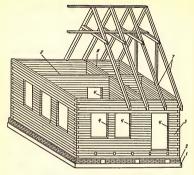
Конструкция брусчатых стен и стропил дома: 1 — фундамент; 2 — цоколь; 3 и 5 — наружная и внутренняя стены; 4 — провемы: 6 — пеоегородка; 7 — стропна;
